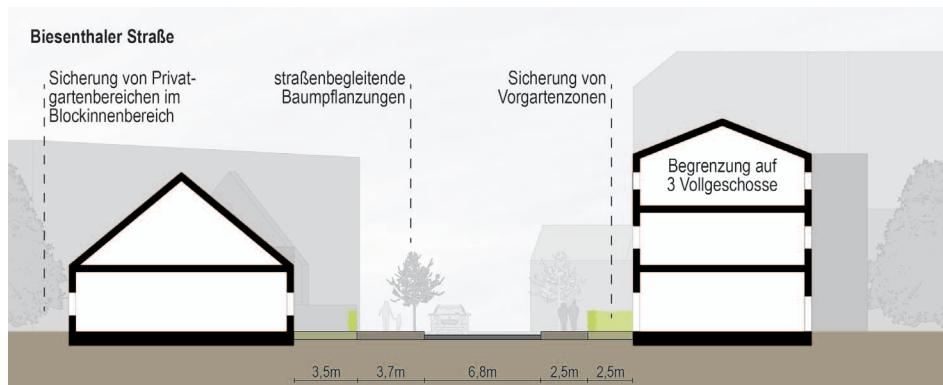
Rahmenplanvertiefung Gründerzeitviertel - Straßenraumprofil der Biesenthaler Straße
